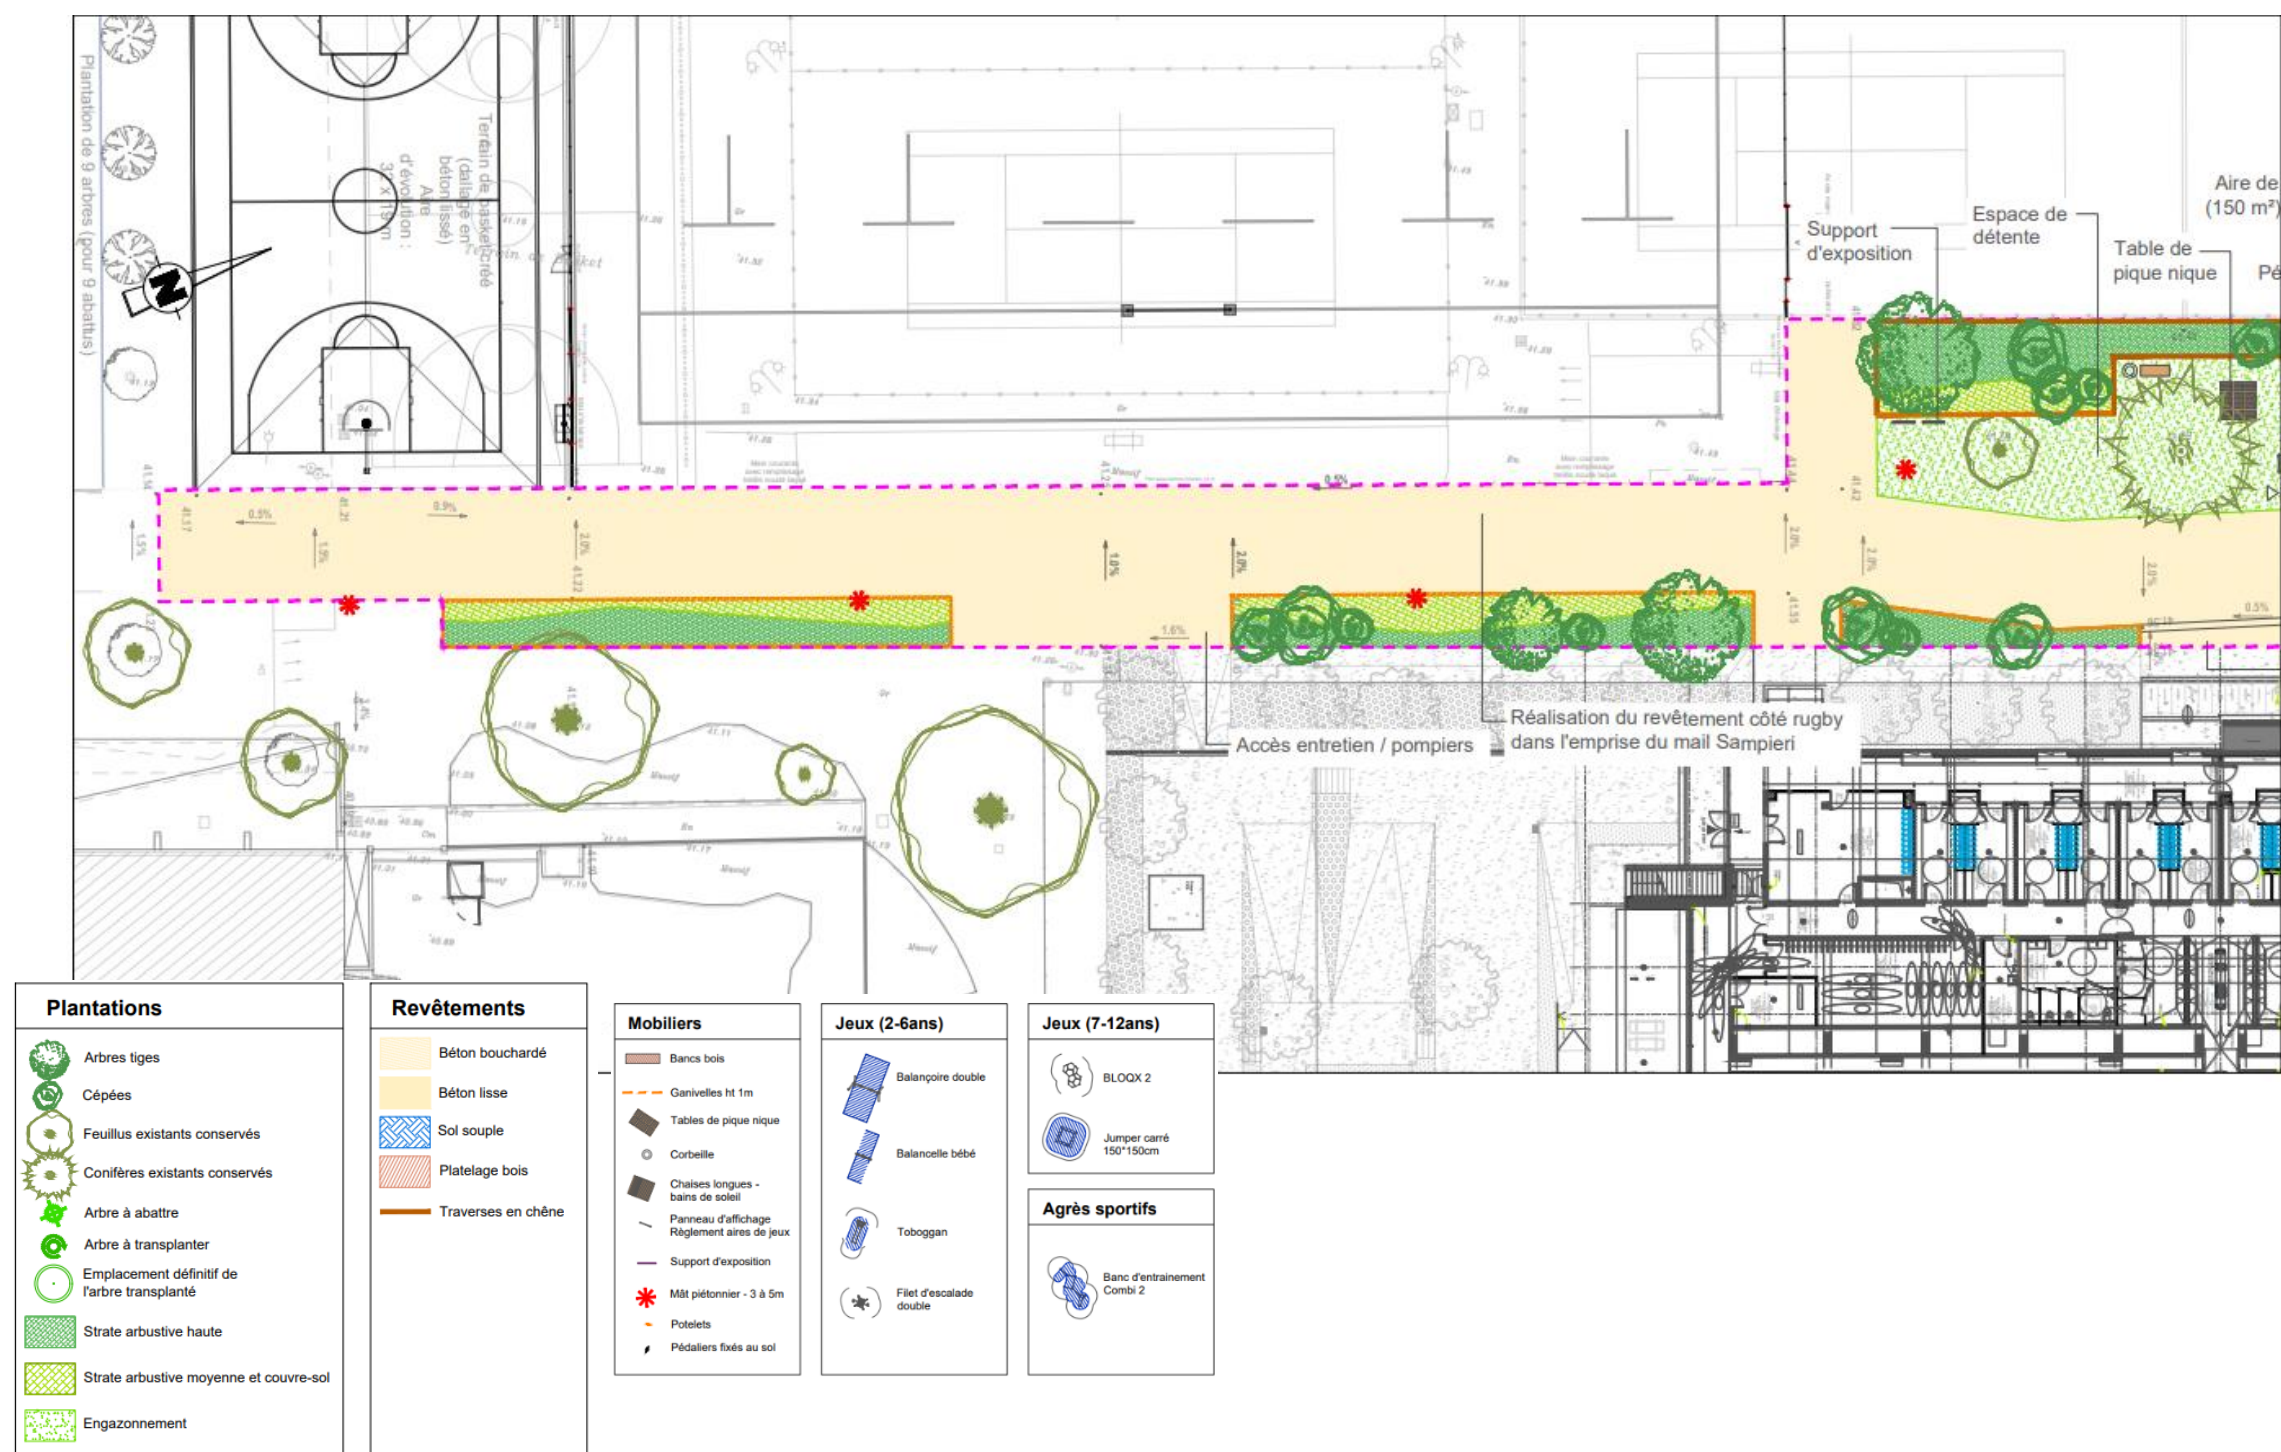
Extrait du plan masse des travaux de construction du mail piétons/cycles SAMPERI – planche 2/2 (Source : Ville de Mérignac)
